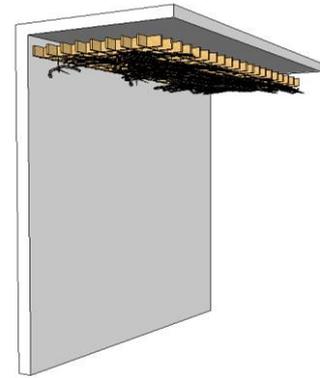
Tampak depan penerapan akar wangi sebagai ornamen plafon pada ruang *whirlpool
